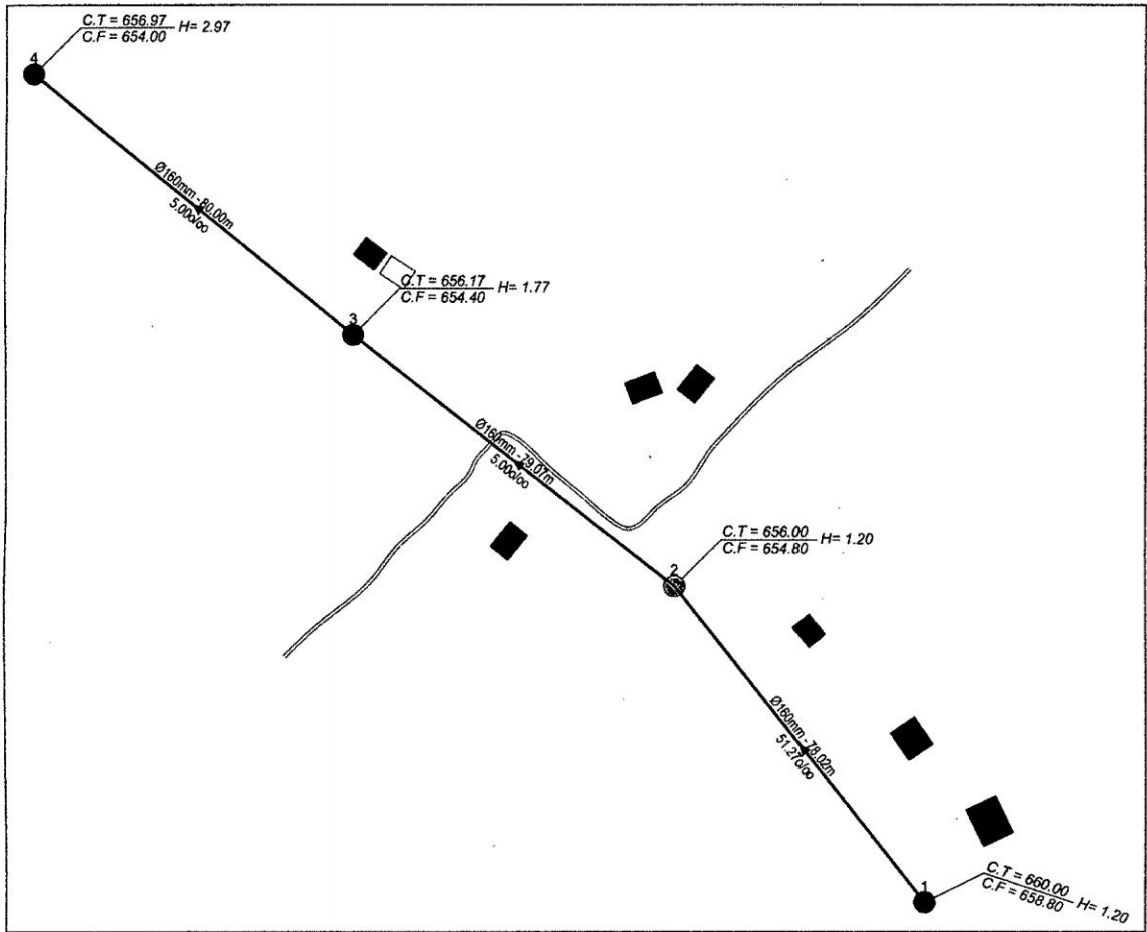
Plano en planta y diagrama de flujo del buzón N° 1 a 4. Fuente: Elaboración propia
